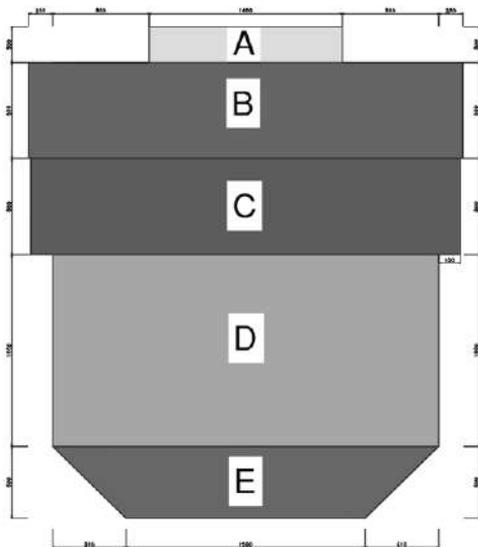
Rencana Denah Lantai 2 (Komposit)
